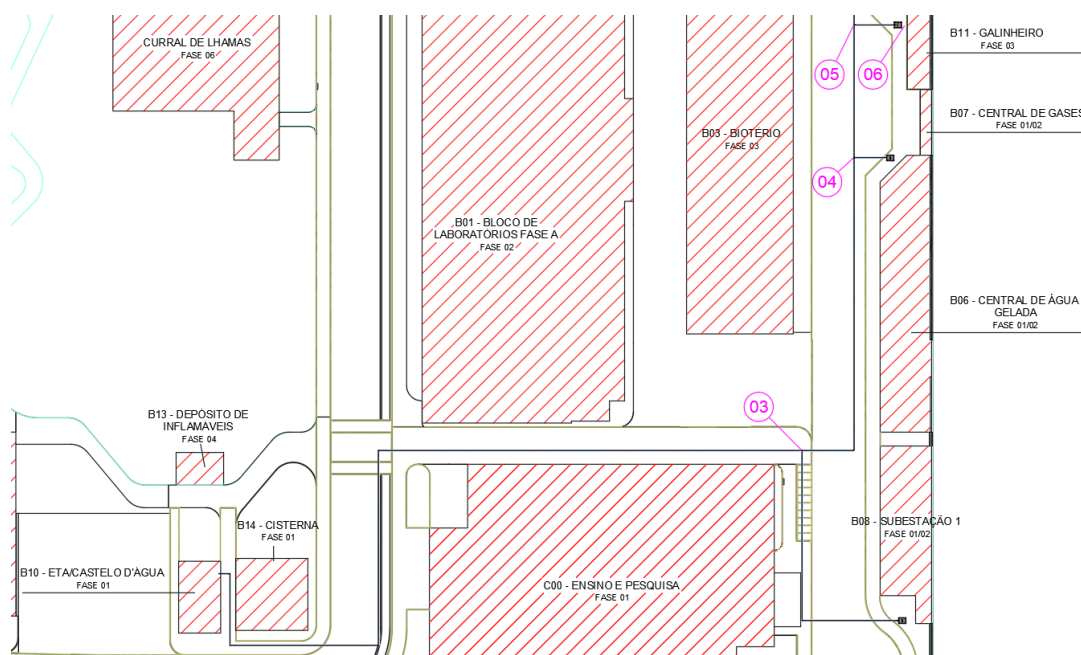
Planta trecho (Castelo d'água / Bloco B11)
